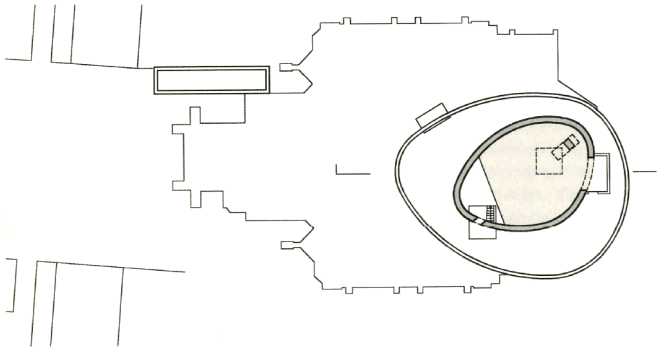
Planta Capilla de la Reconciliación. La planta de la antigua iglesia ahora es una plaza, en la zona del coro es donde se construye yergue la construcción actual.
